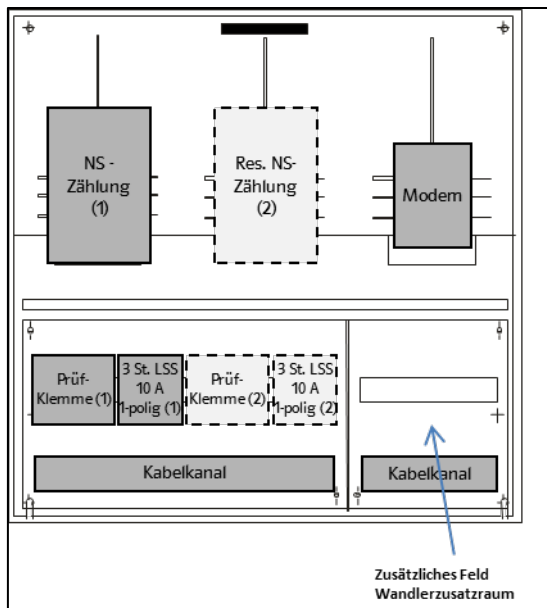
Schema Isolierstoffmontageplatte nach VBEW Merkblatt
